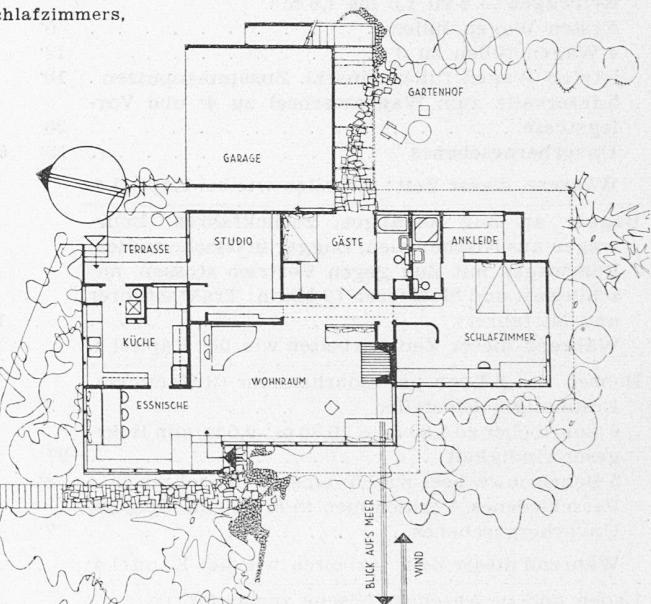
Haus Beckstrand, Grundriss 1:300
